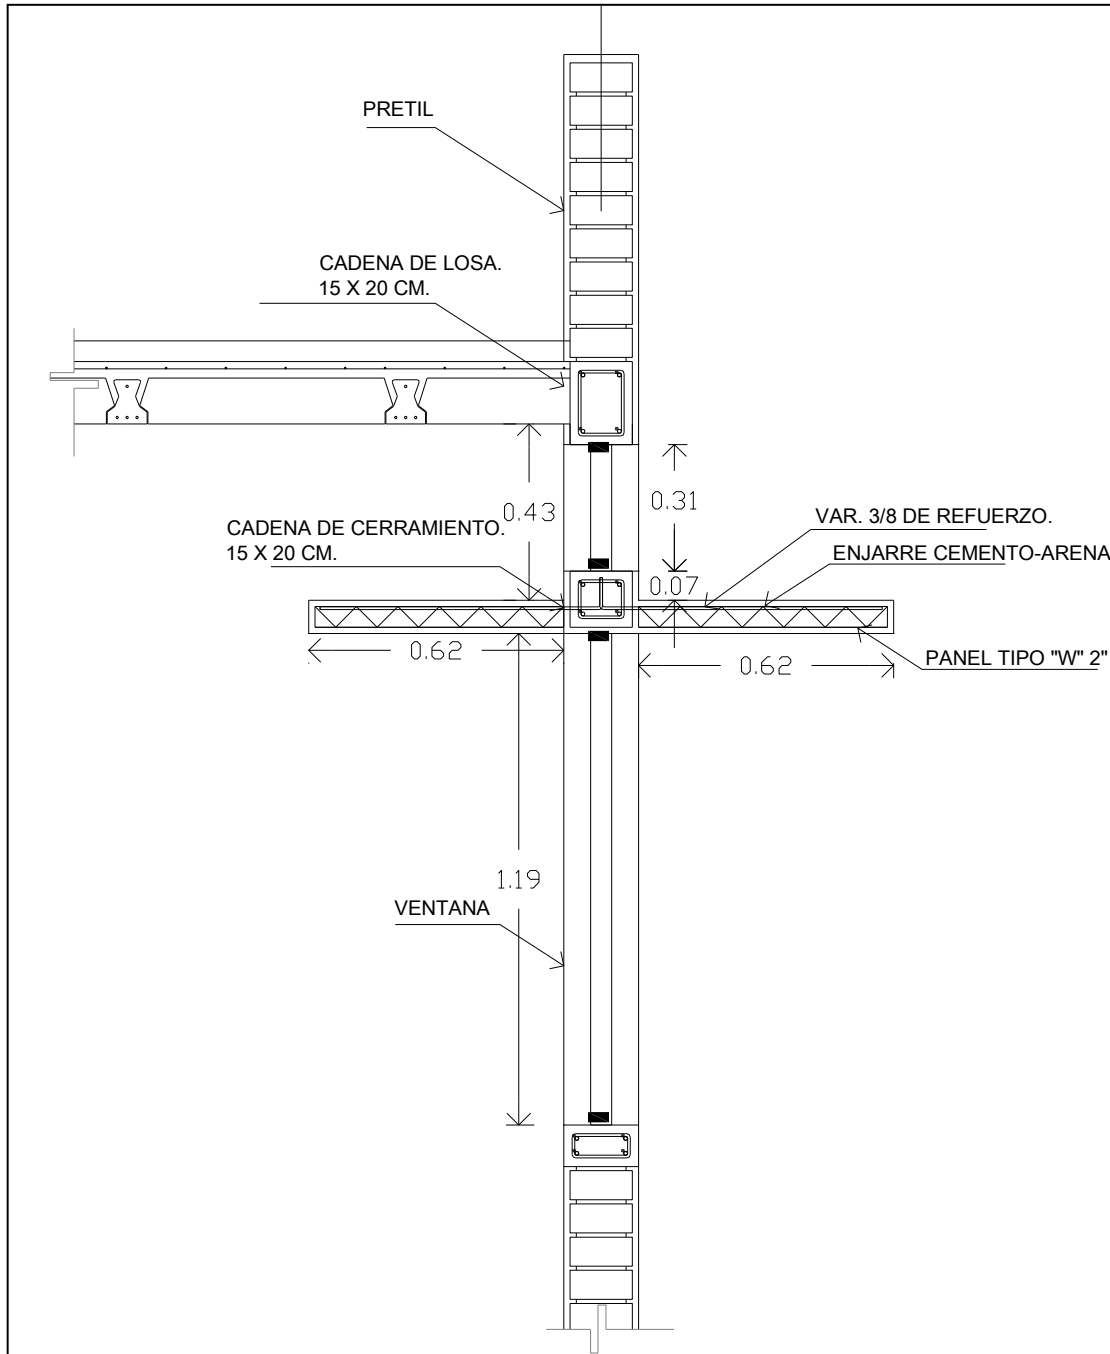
Detalle constructivo de alero doble hacia el interior del espacio arquitectónico.
